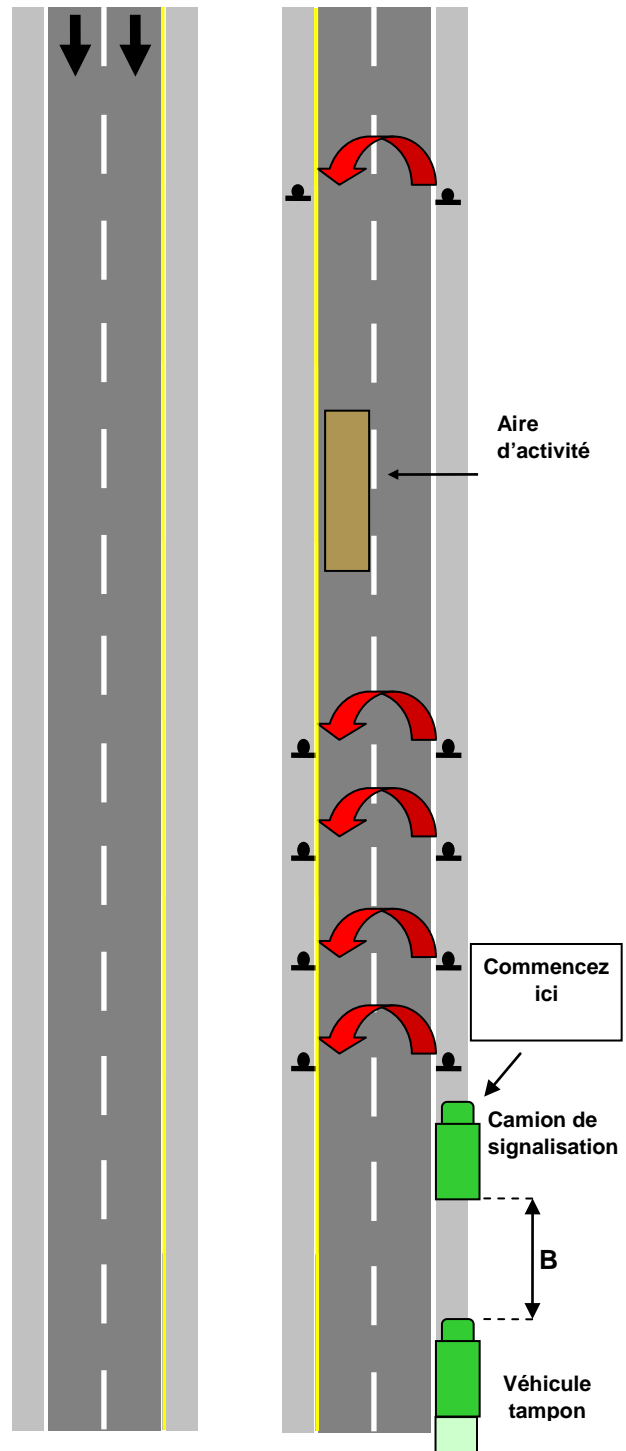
Installation des panneaux (routes à voies multiples à chaussées séparées)
